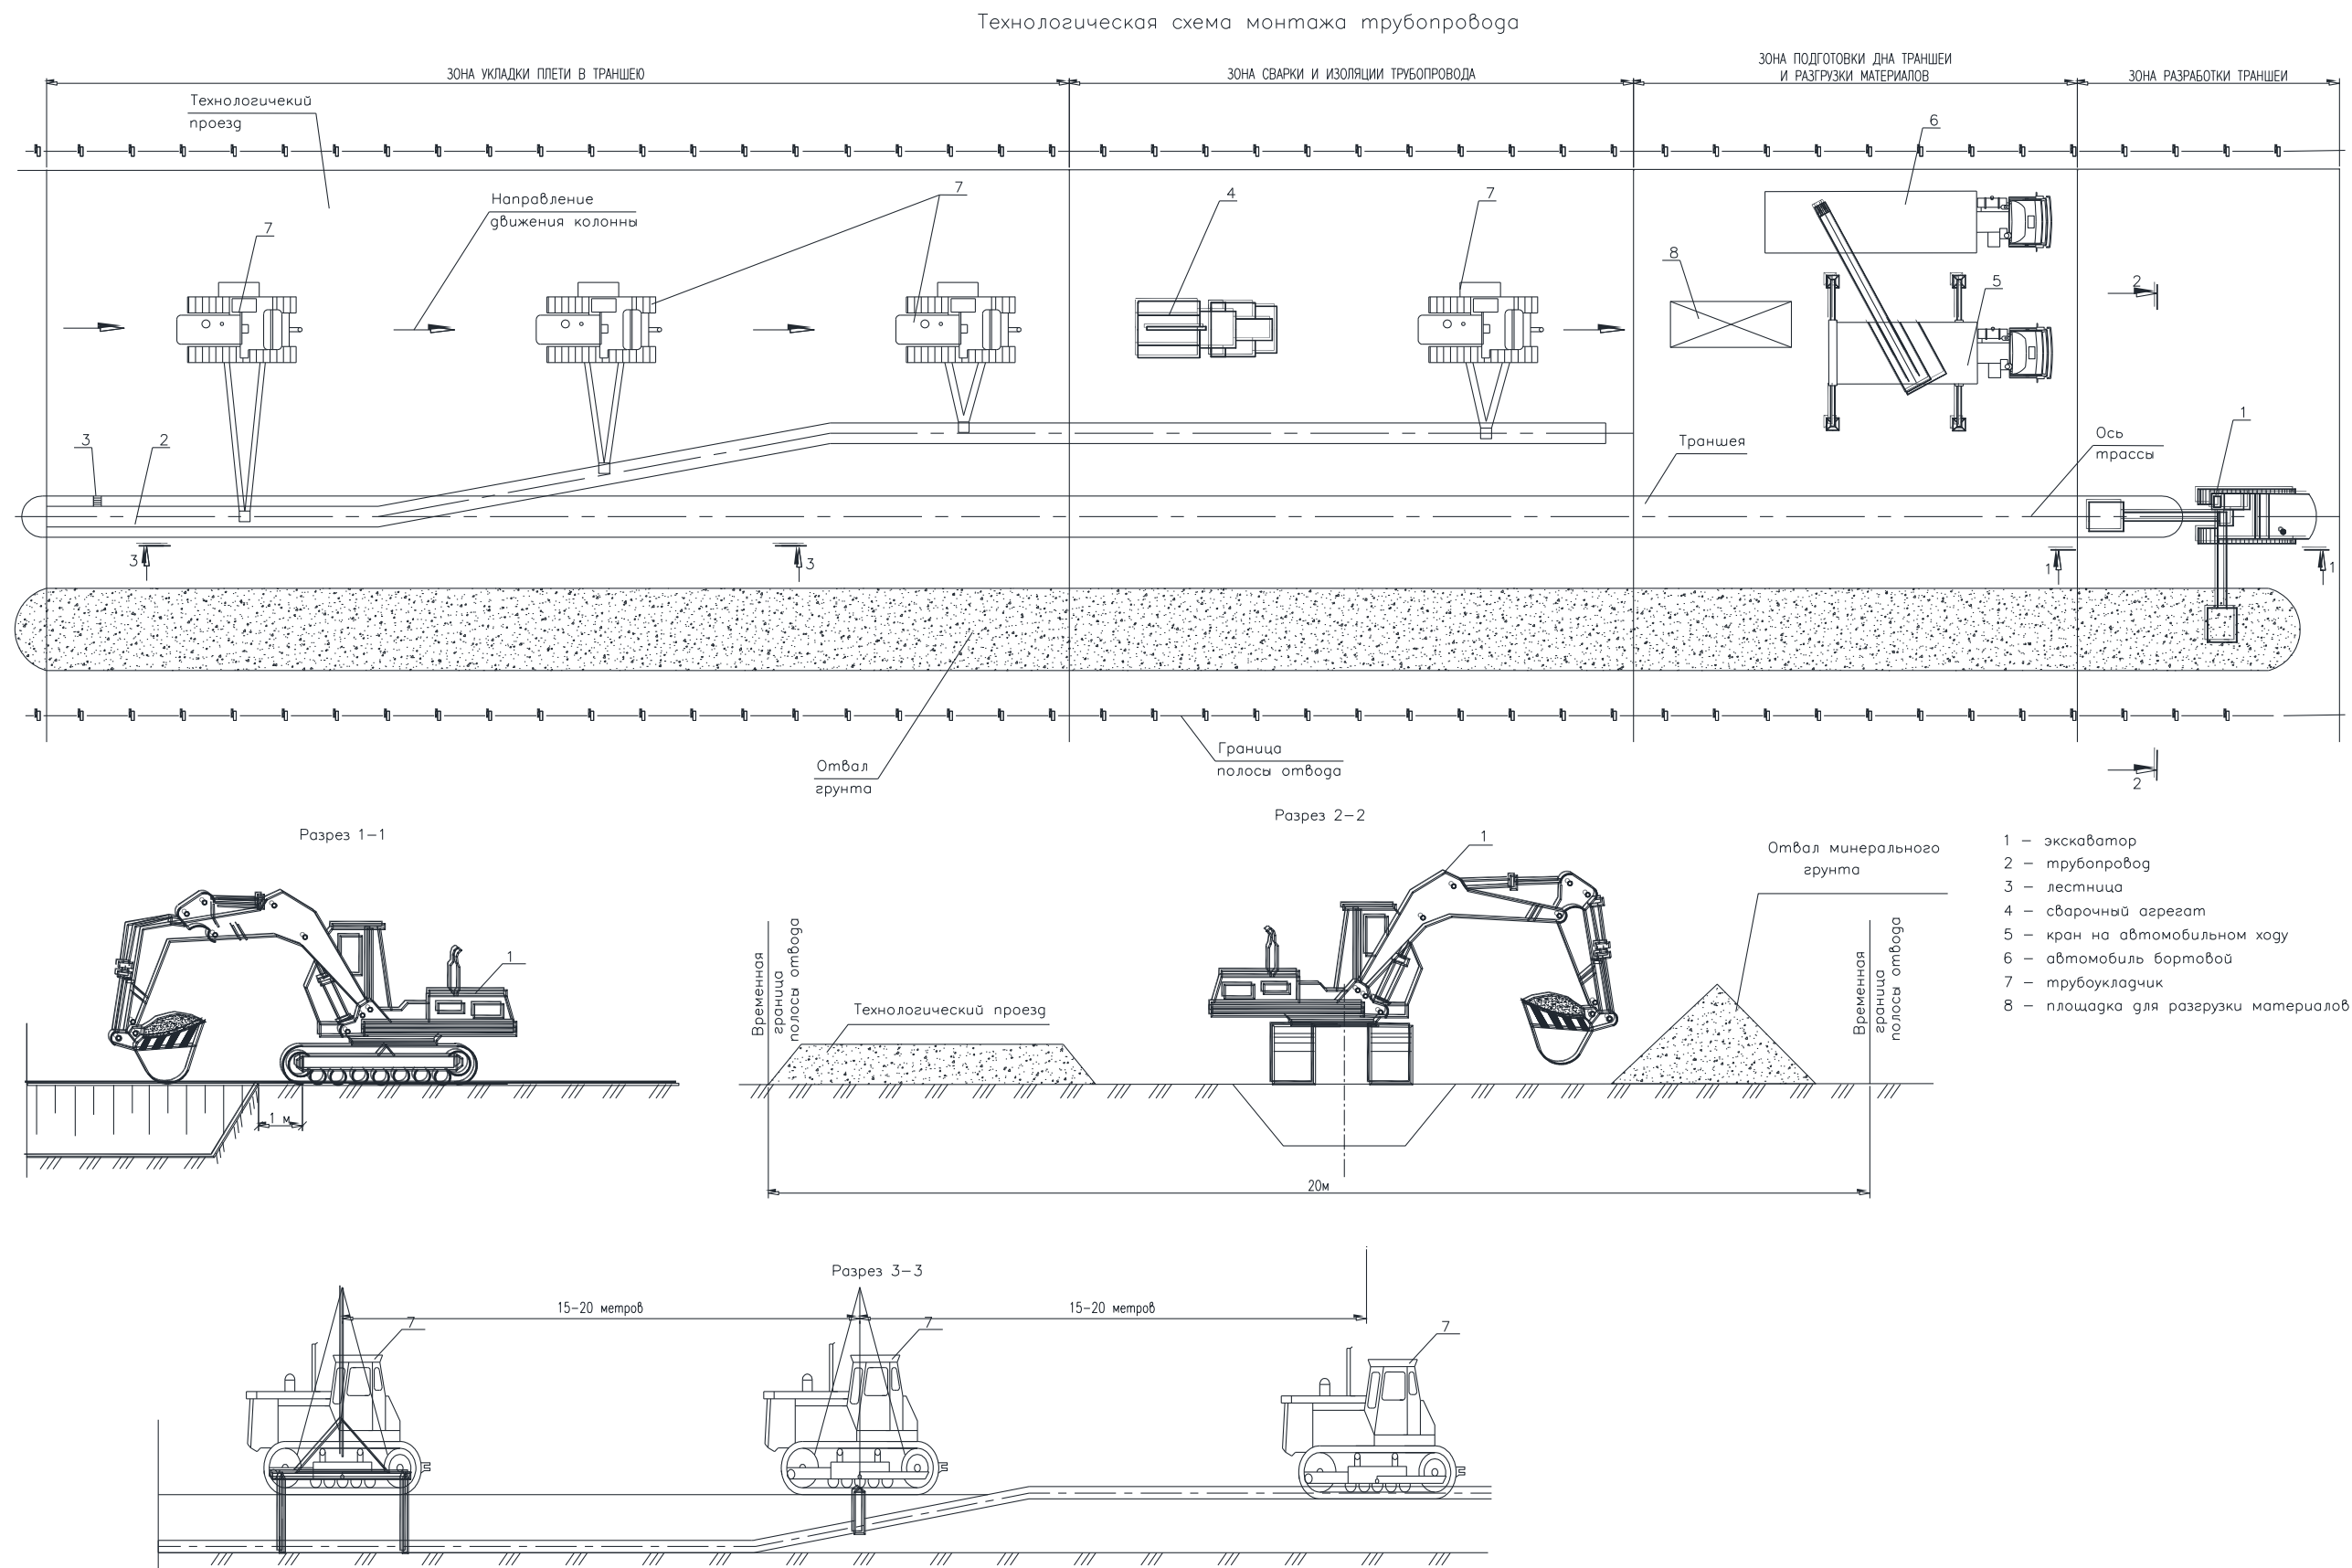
Типовая технологическая схема монтажа трубопровода
